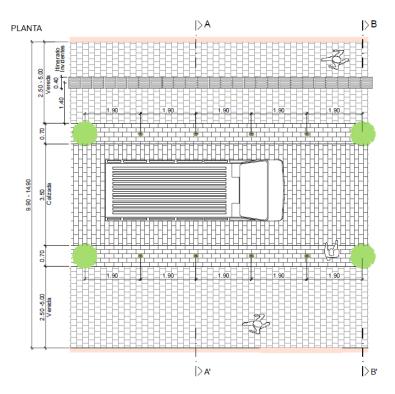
Detalle planta propuesta peatonalización Jr. Orbegoso y Almagro
